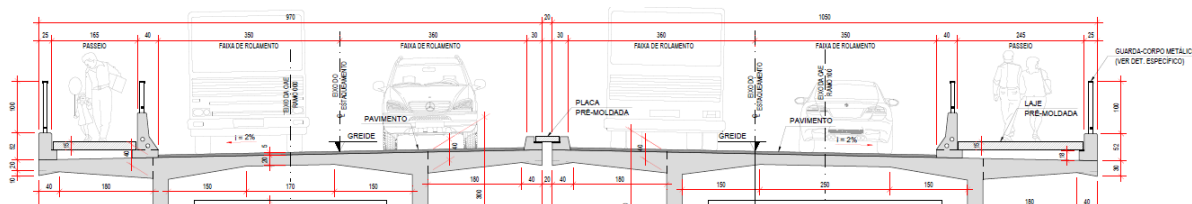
SEÇÃO TRANSVERSAL TÍPICA DO ENCONTRO ESTRUTURADO
